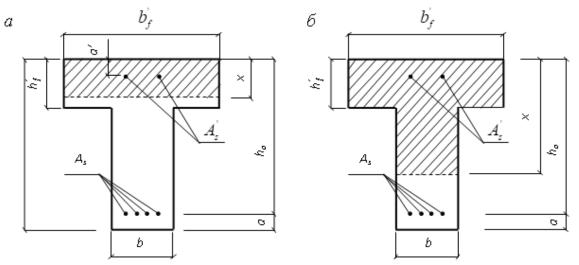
Положение границы сжатой зоны в сечении изгибаемого железобетонного элемента: a - в полке; δ - в ребре
